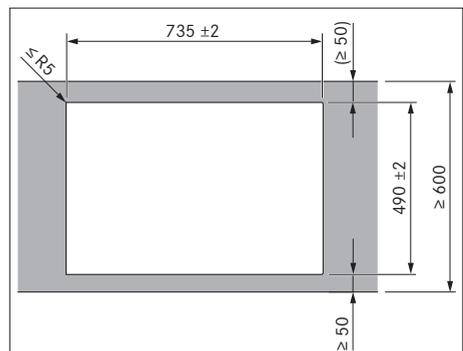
Dimensioni di taglio per montaggio sopra piano
